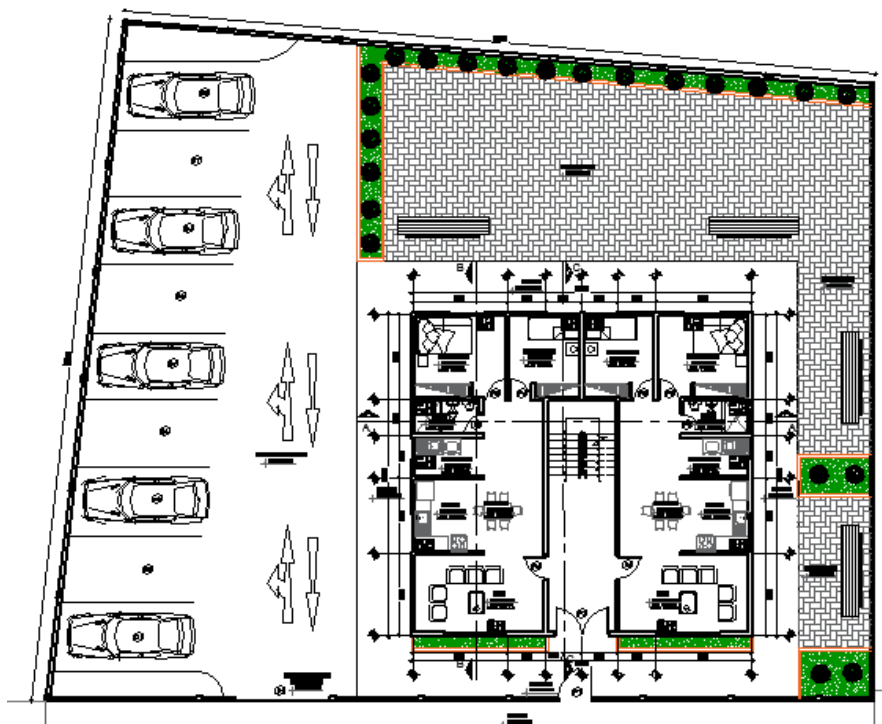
Vista en planta de la arquitectura general del Proyecto (Fuente: Elaboración propia).
